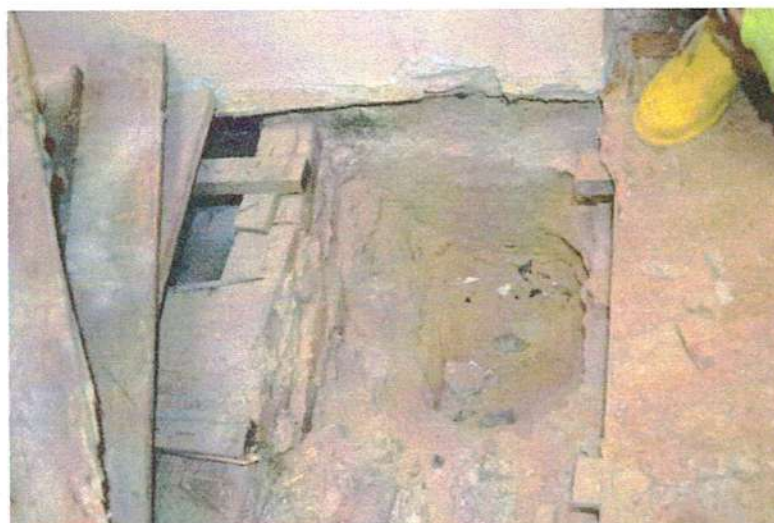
Шурф фундаментов, отсутствие вертикальной гидроизоляции, увлажнение фундаментов
